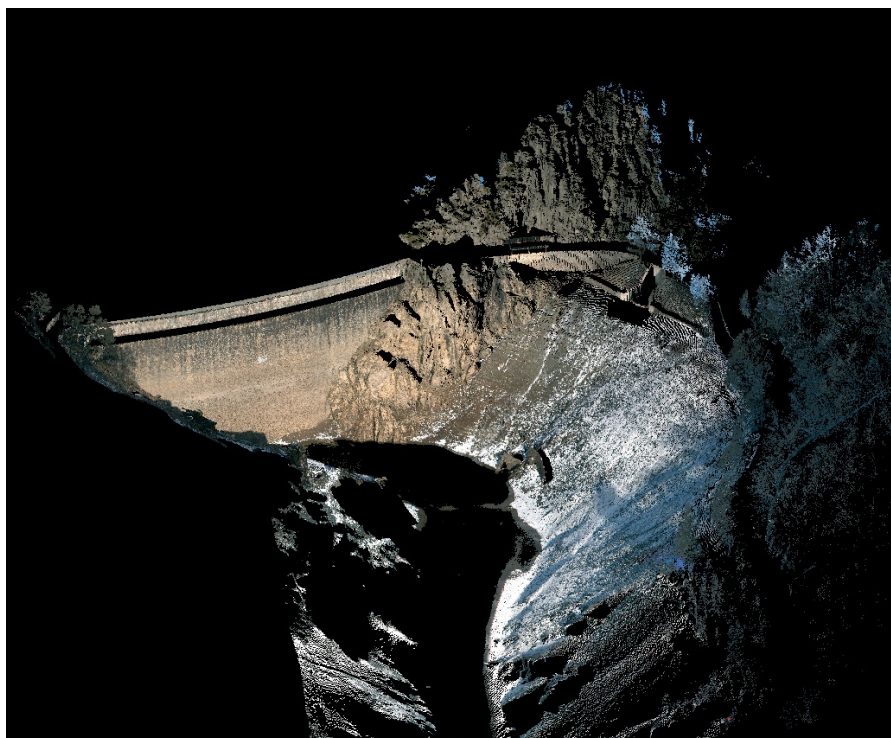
Archive 3D (XYZRVB) du parement amont du barrage du Gouffre d'Enfer (Loire).
